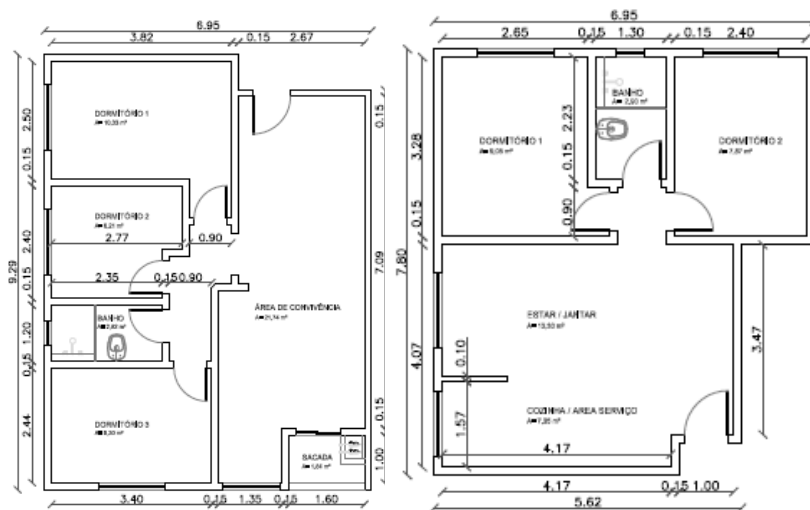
Plantas baixas técnicas. a) Apartamento Tipo A, b) Apartamento Tipo B.
